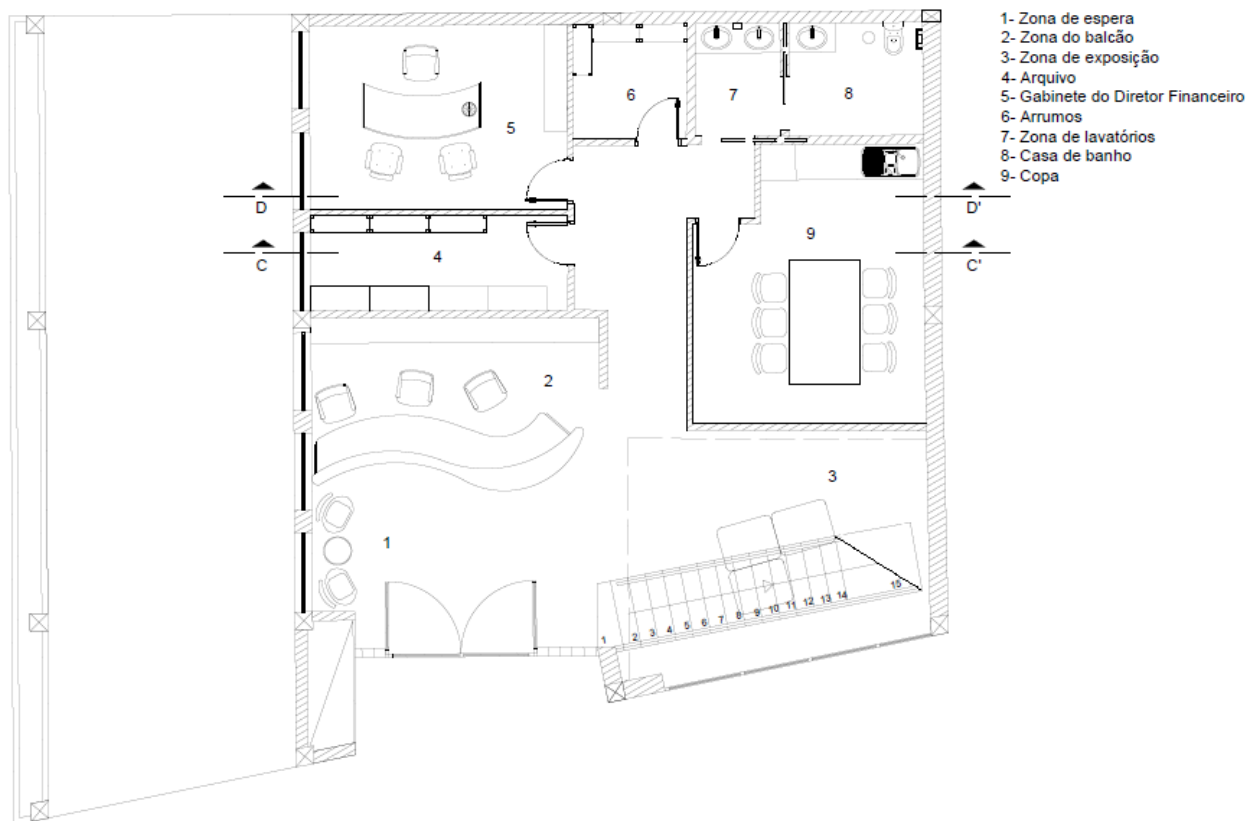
Planta Piso 0. Fonte: Ana Cândido
